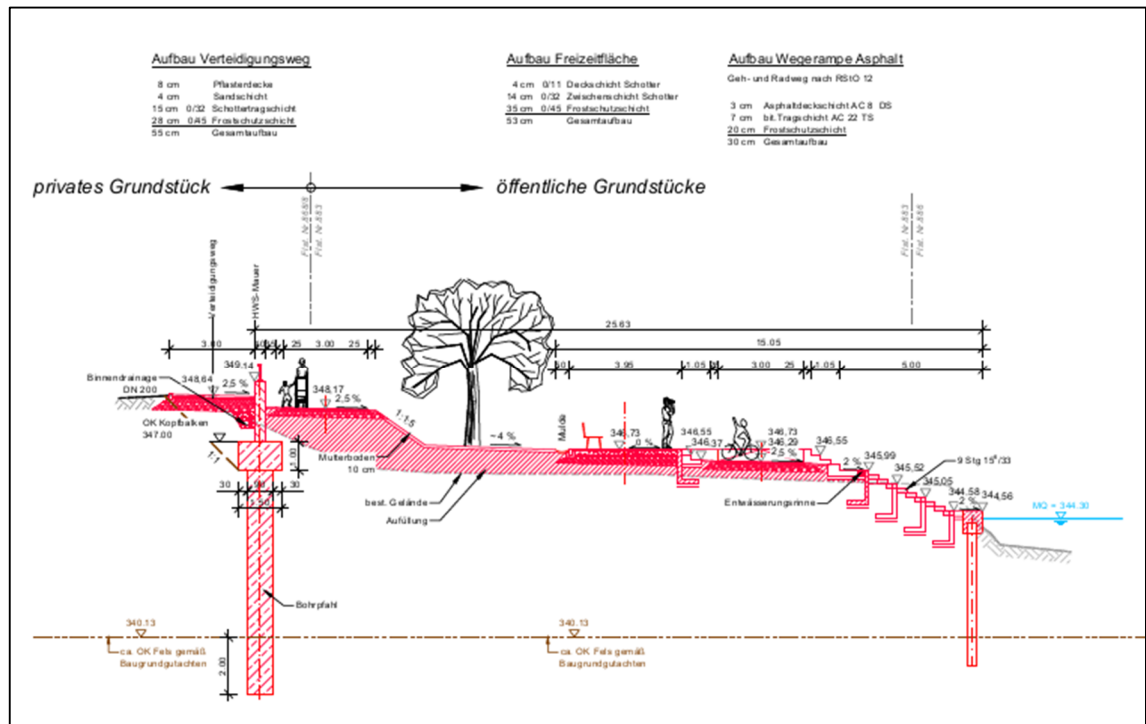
HWS-Mauer mit Wegerampe Schnitt B-B
